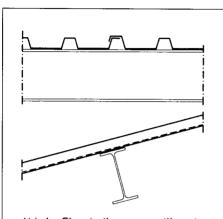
Einschaliges ungedämmtes Trapezprofildach-Dachdeckung
